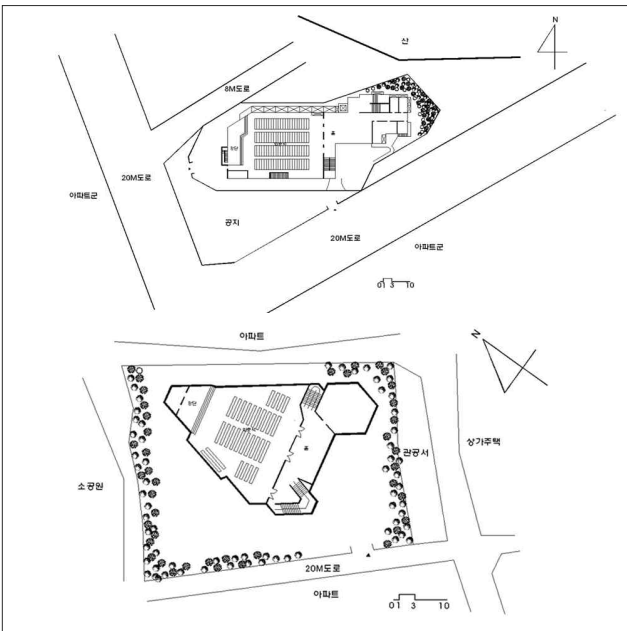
S2(상) S3(하)교회 배치도 및 평면도
